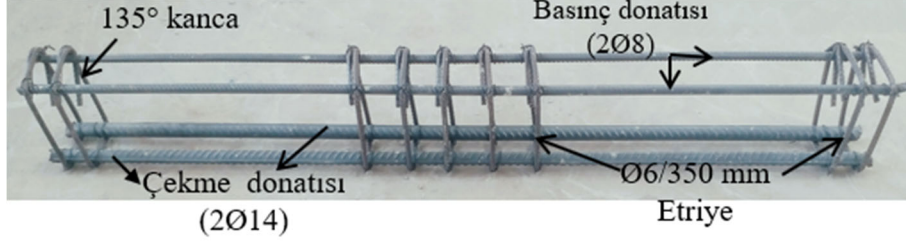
Deney kirişlerinin boyutları donatı detayı
